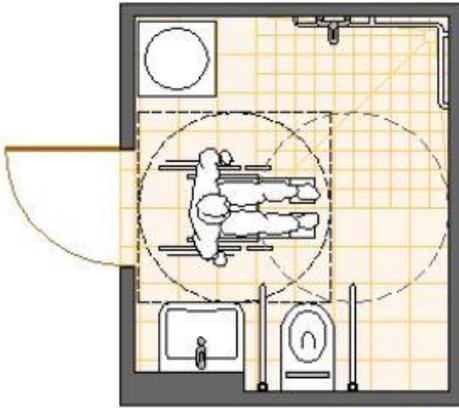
Grundriss Badezimmer³⁷
